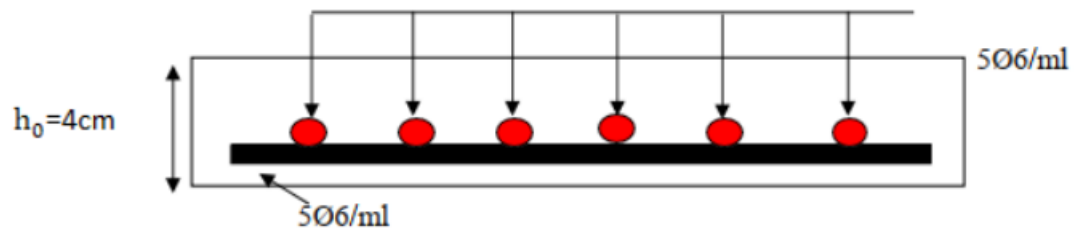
Schéma de ferrailage de la dalle de compression
